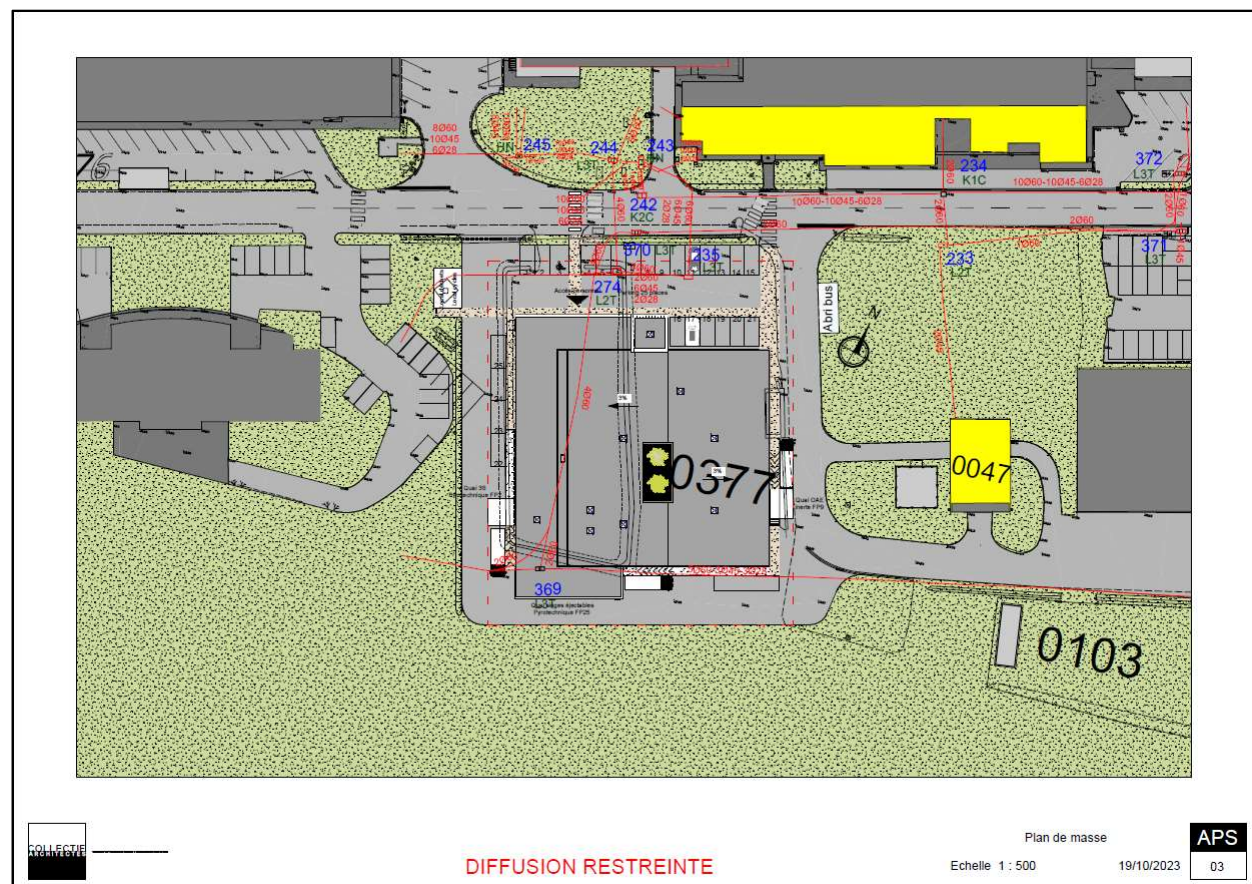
Plan de masse du projet (Collectif d'Architectes, octobre 2023)
